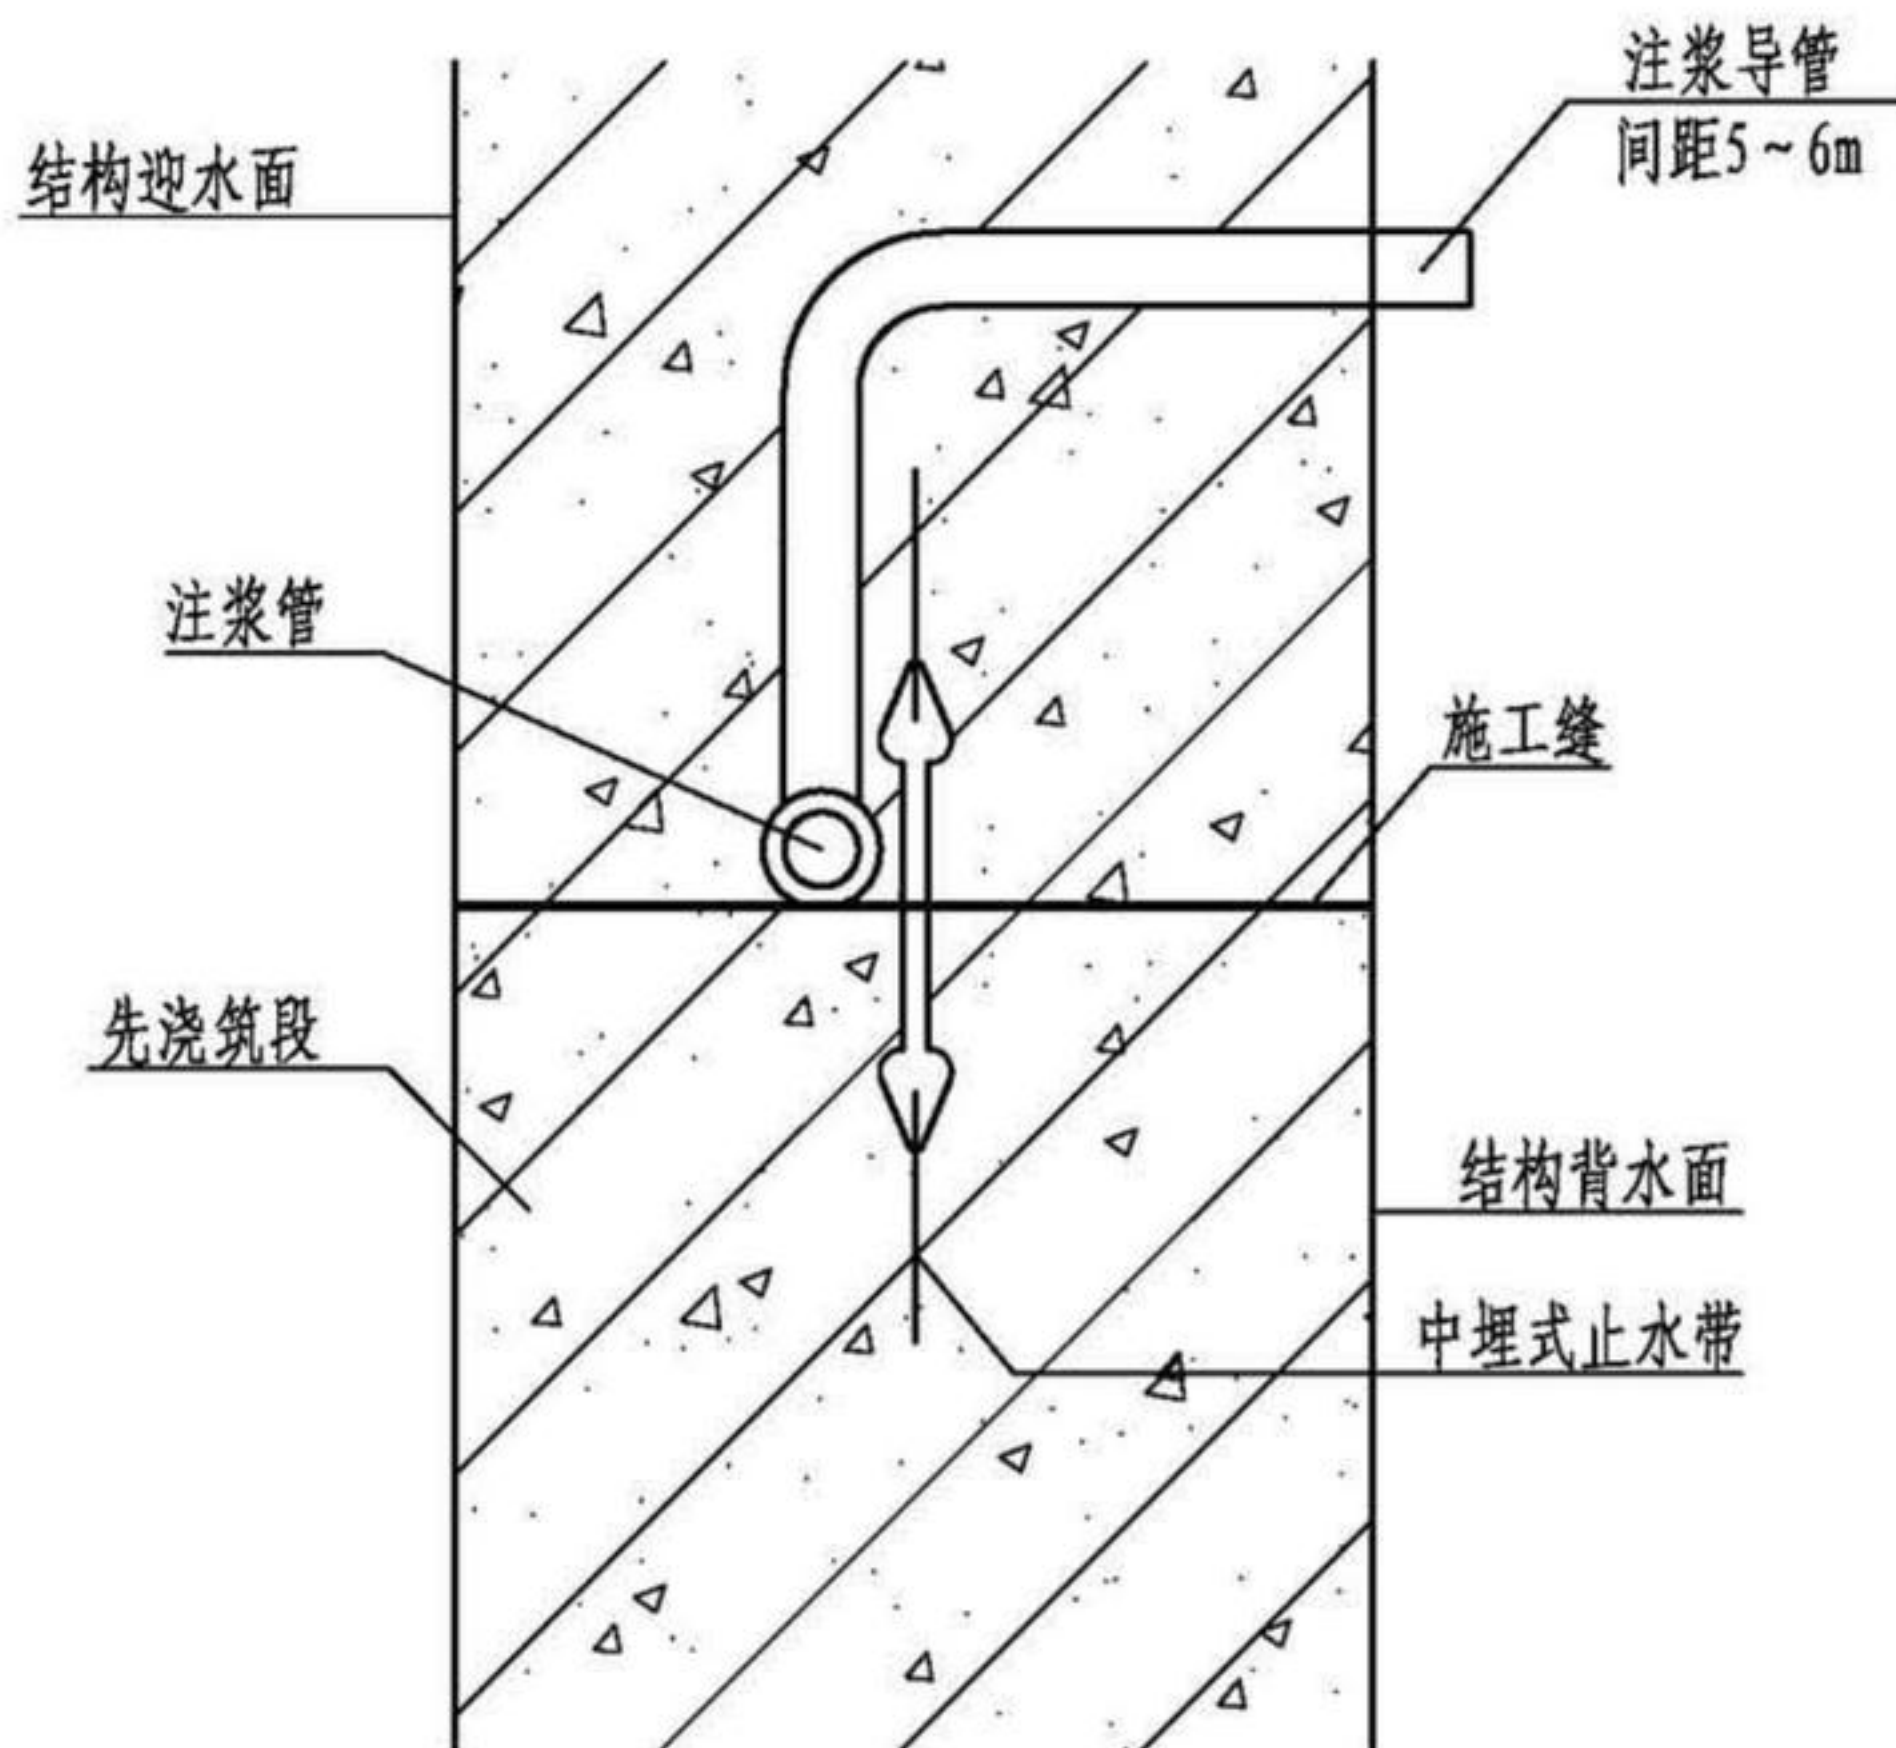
侧墙（环向）垂直施工缝防水构造示意图
